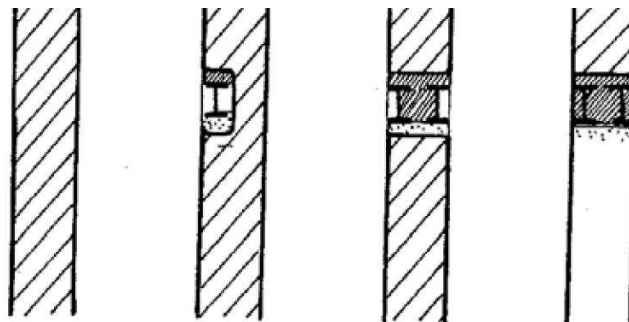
Construcción de un dintel con perfiles metálicos
